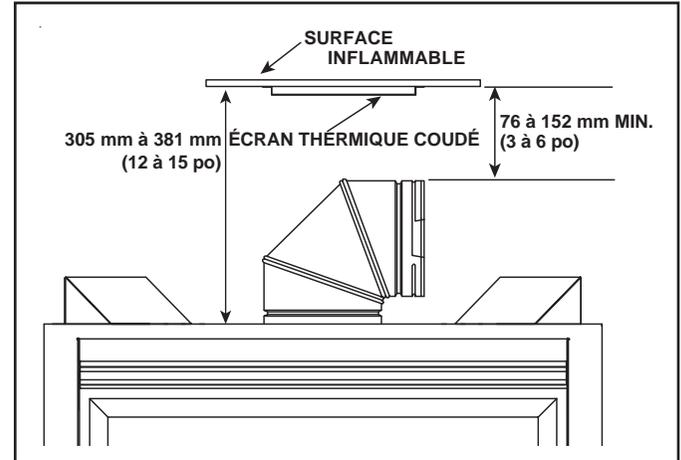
Emplacement d'installation de l'écran thermique coudé
